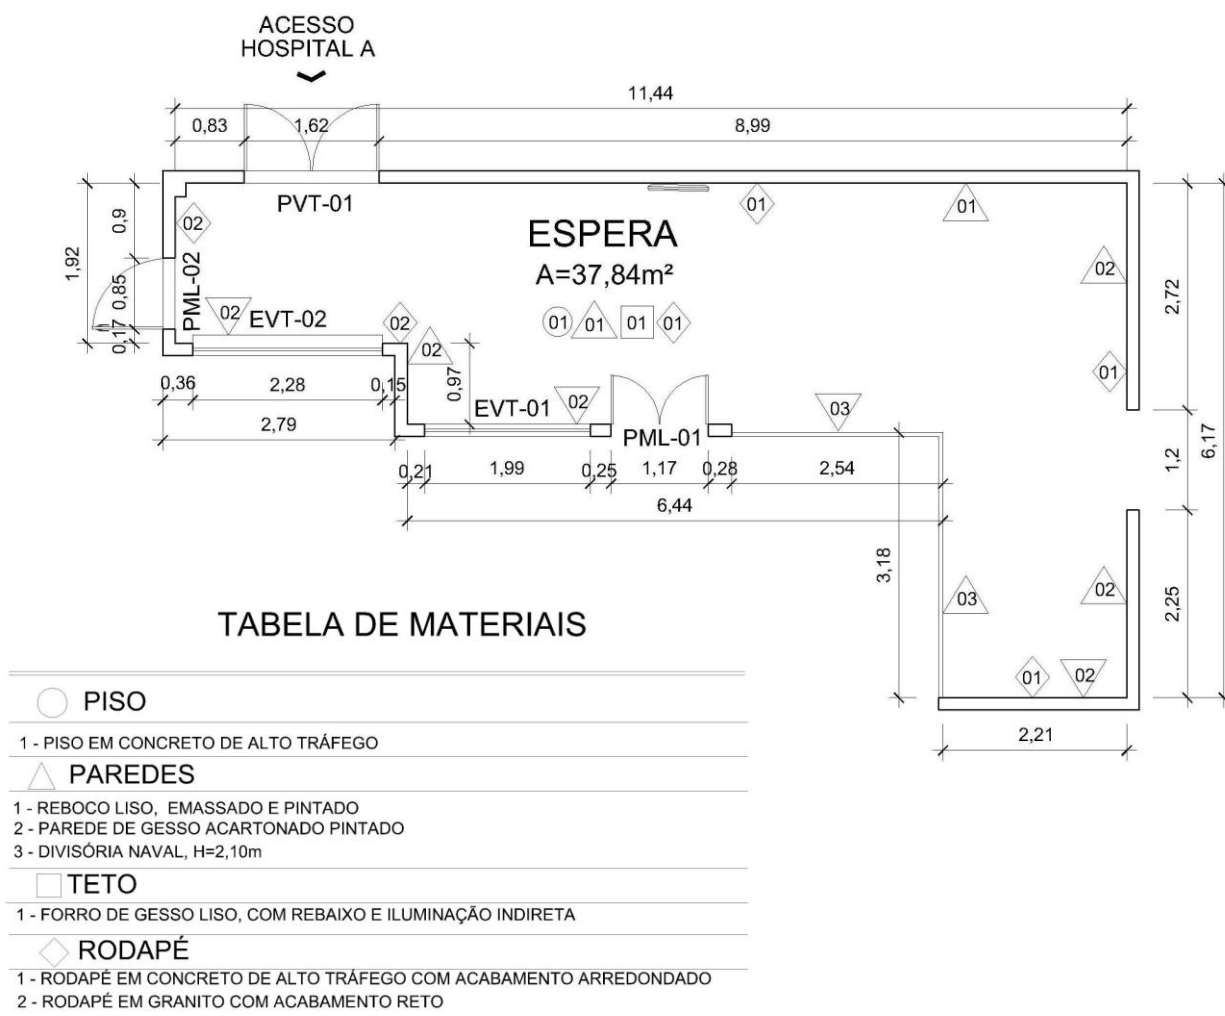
Planta baixa da sala de recepção e espera de pacientes.
